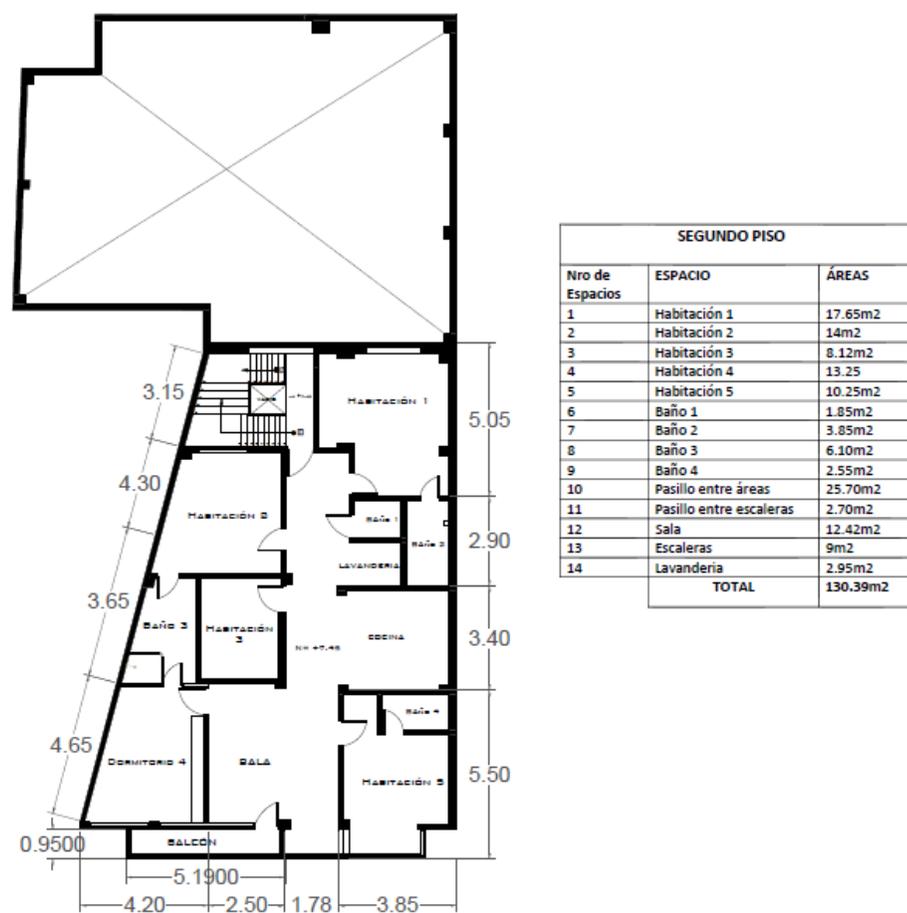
Planta arquitectónica con cuadro de área estado Actual
